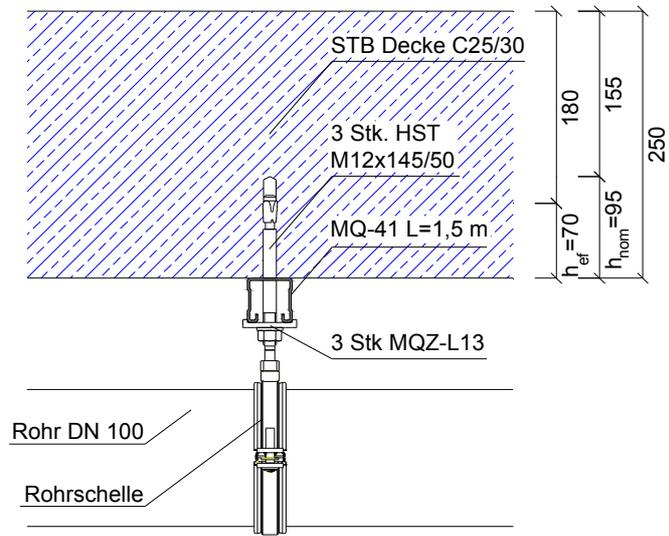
Anschlussdetail H1 Dübel Variante 1 (Maße in mm)
